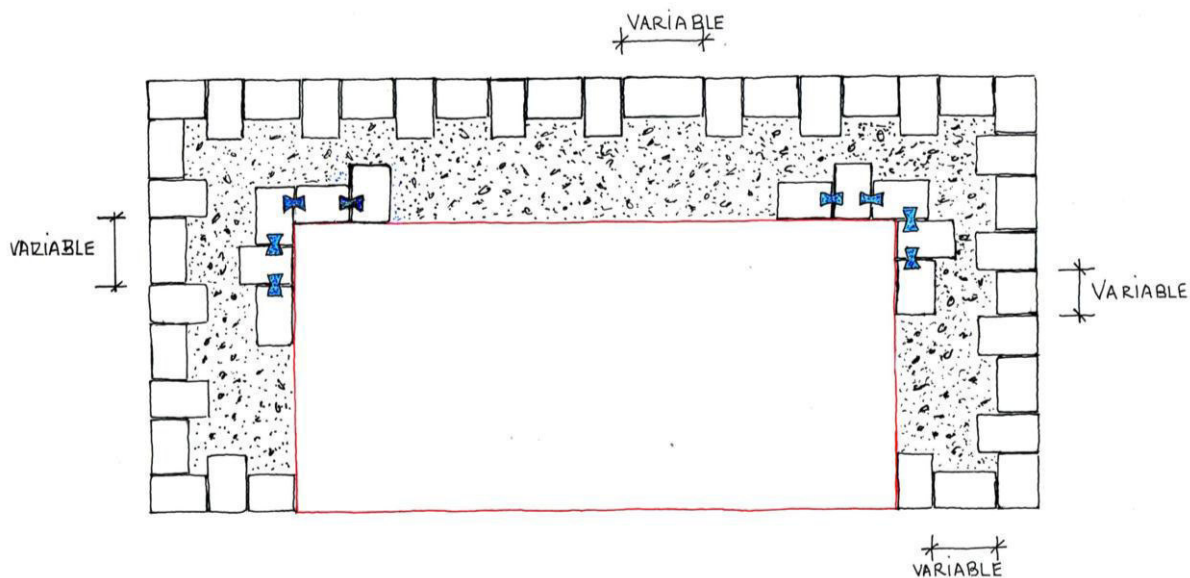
Croquis de la sección horizontal de los paramentos de sillería
